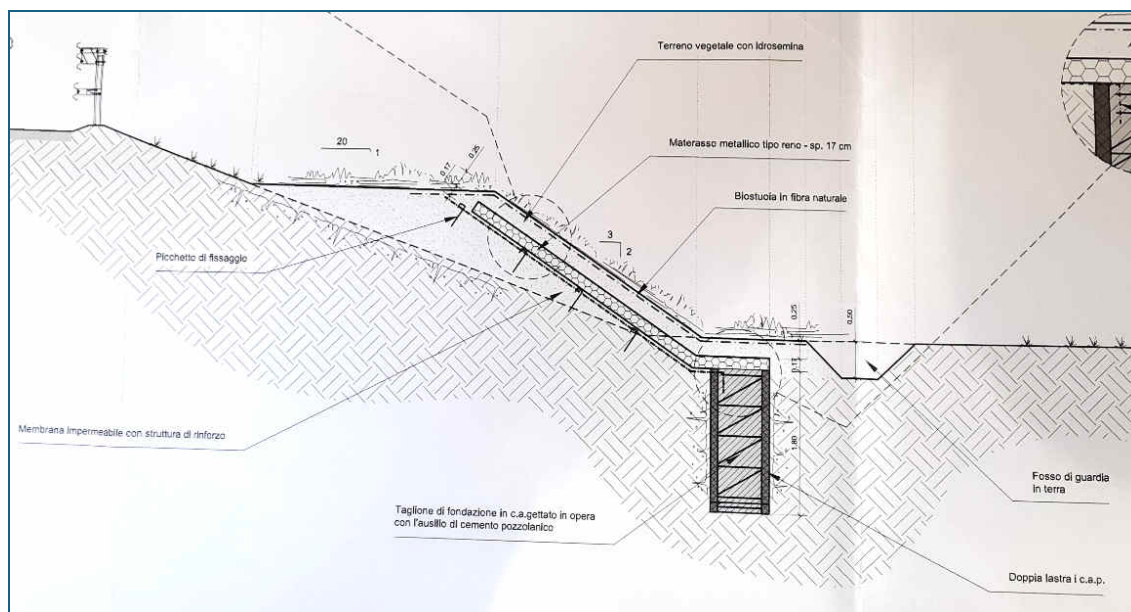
Sezione tipica intervento sistematico di protezione ed impermeabilizzazione
